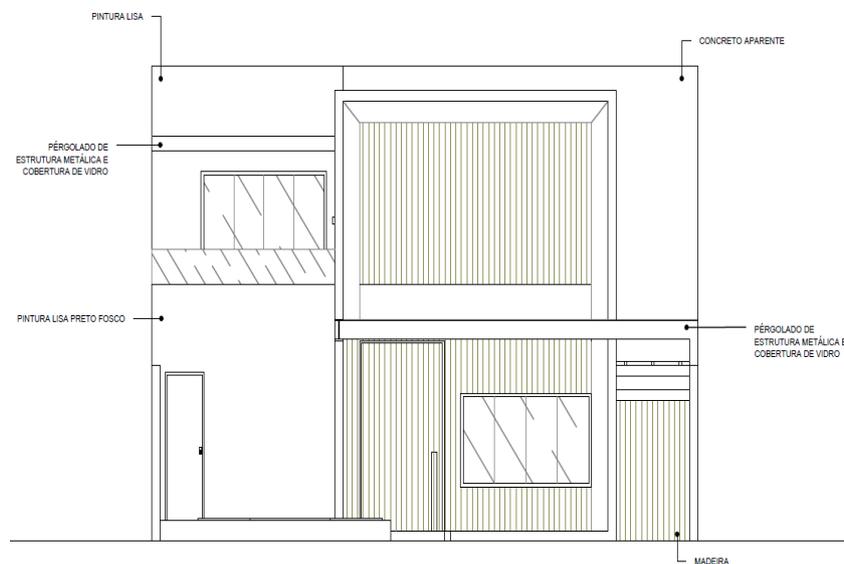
Fachada Frontal do edifício (ADAPTADO DO PROJETO ORIGINAL, 2018).
